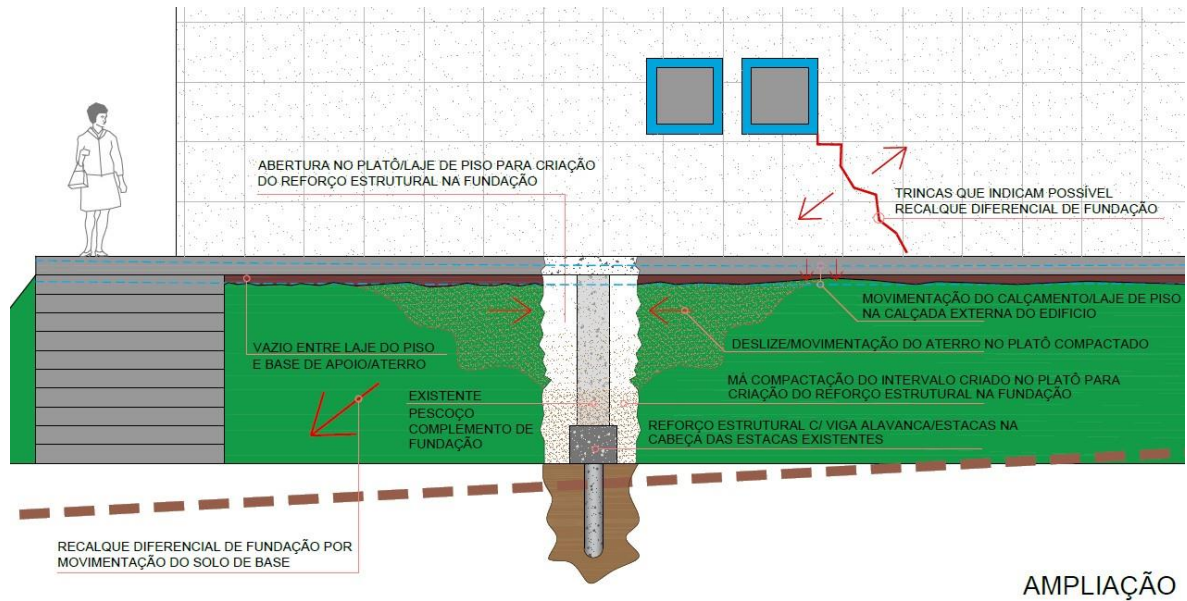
Croqui esquemático da viga alavanca executada como reforço. (Fonte: TECNOPLAN)
